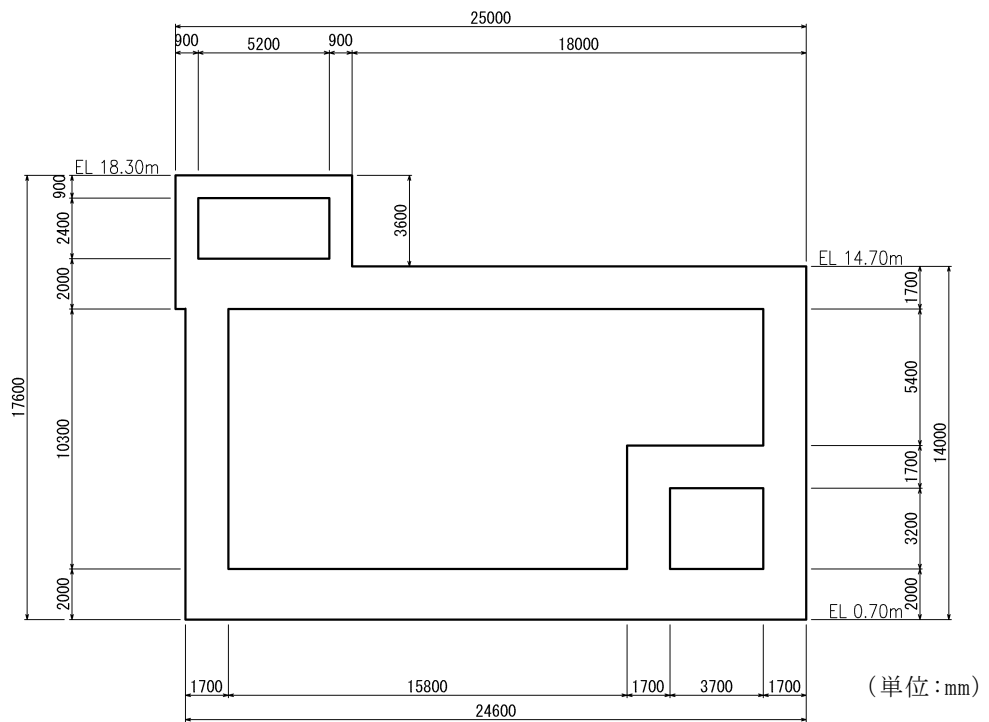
第 1 ベントフィルタ格納槽 断面図 (C-C 断面)
